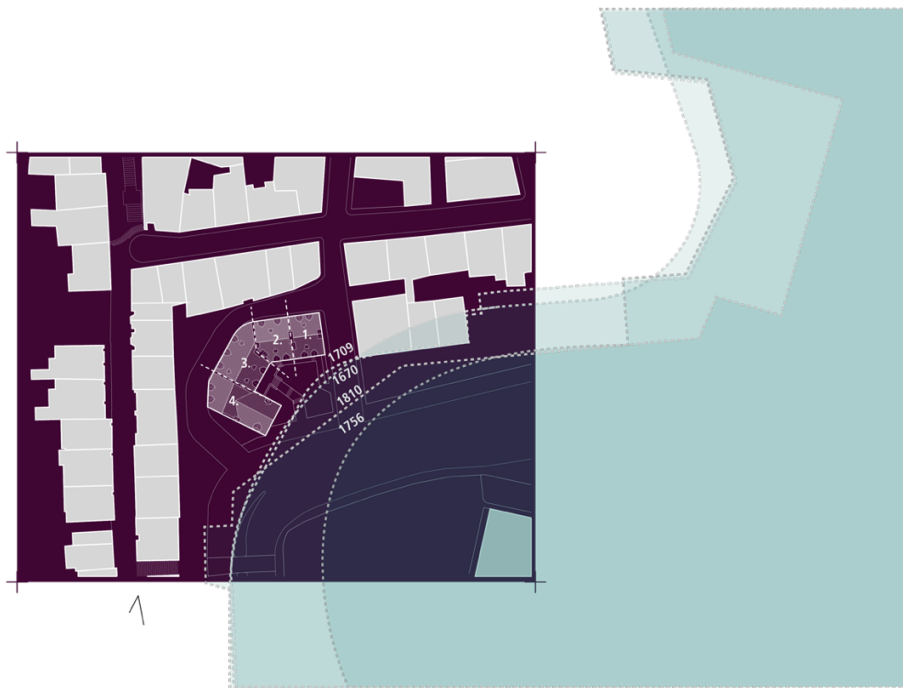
Plan d'implantation de la maison Chevalier avec les différents profils de la Rive.
